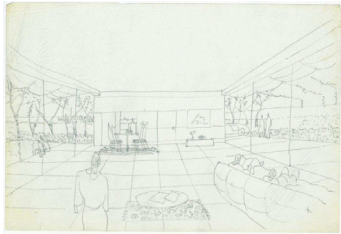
Boceto vista interior, planta baja (Alejandro de la Sota, 1984)
